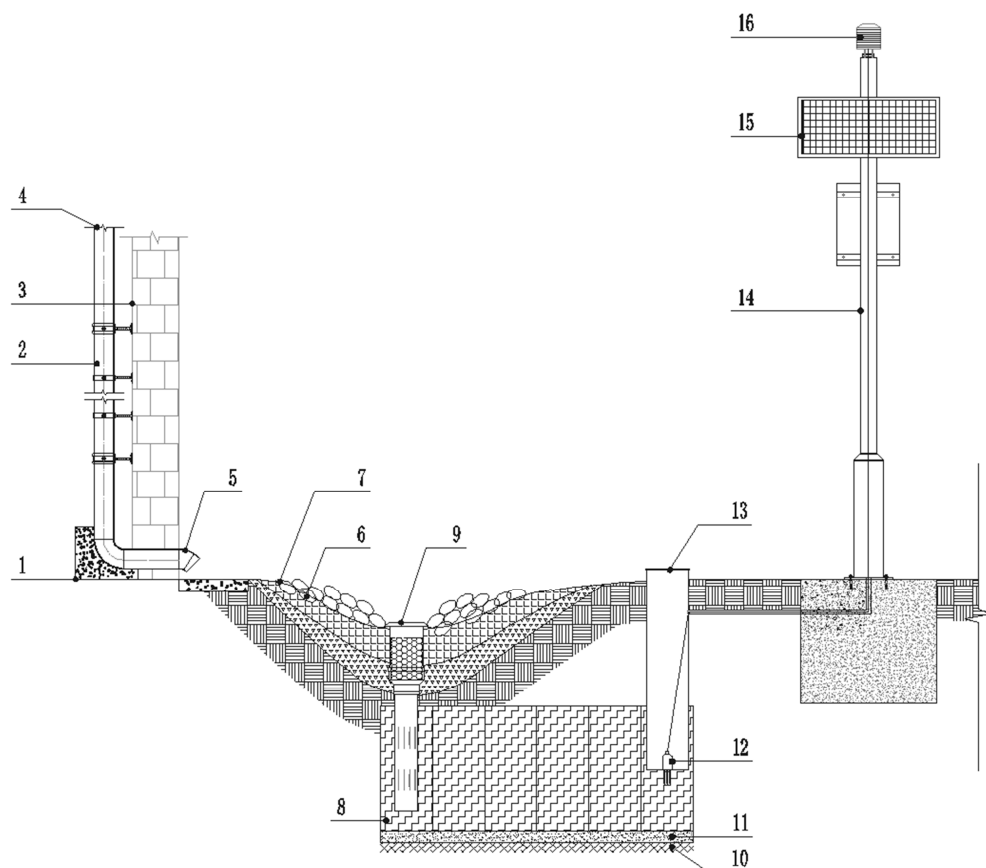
系统与建筑外排水做法应用构造示意图
